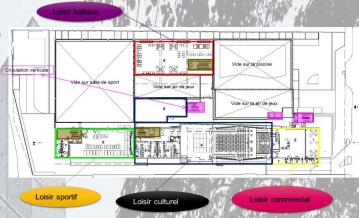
Plan de 1er étage (Centre de loisir Santa Amaro) Source : m.galeriadaarquitetura.com.
